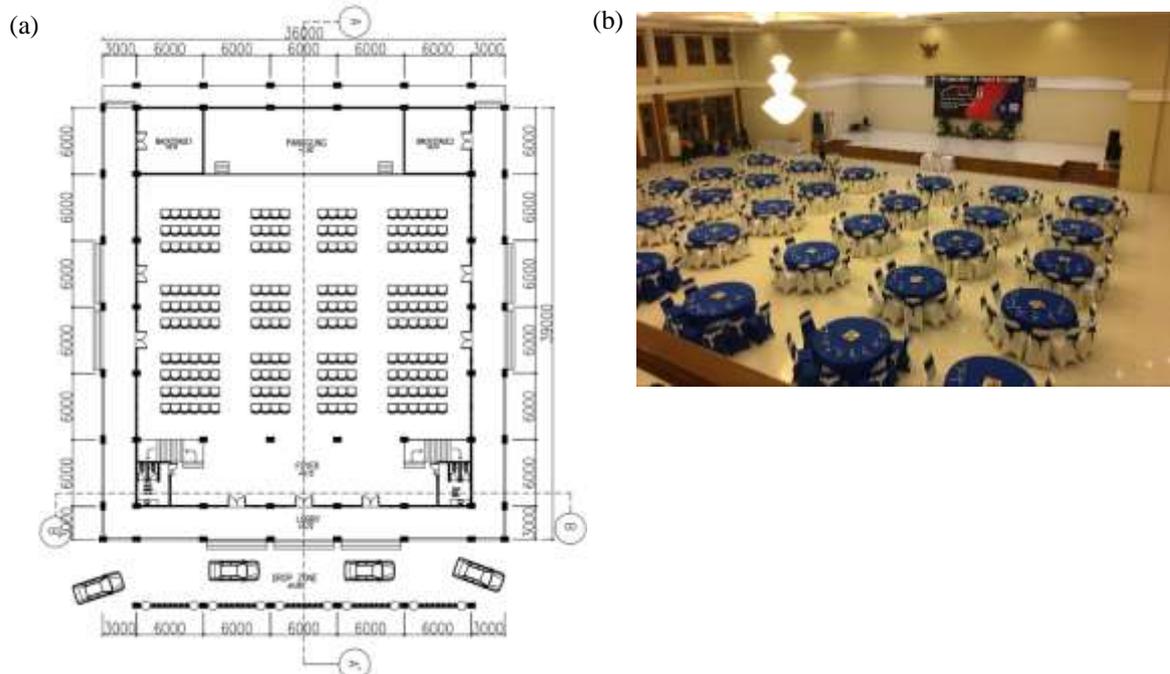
(a) Denah *Ballroom upper floor* Aisawan Resort & Spa (b) *Ballroom* Aisawan Resort & Spa
